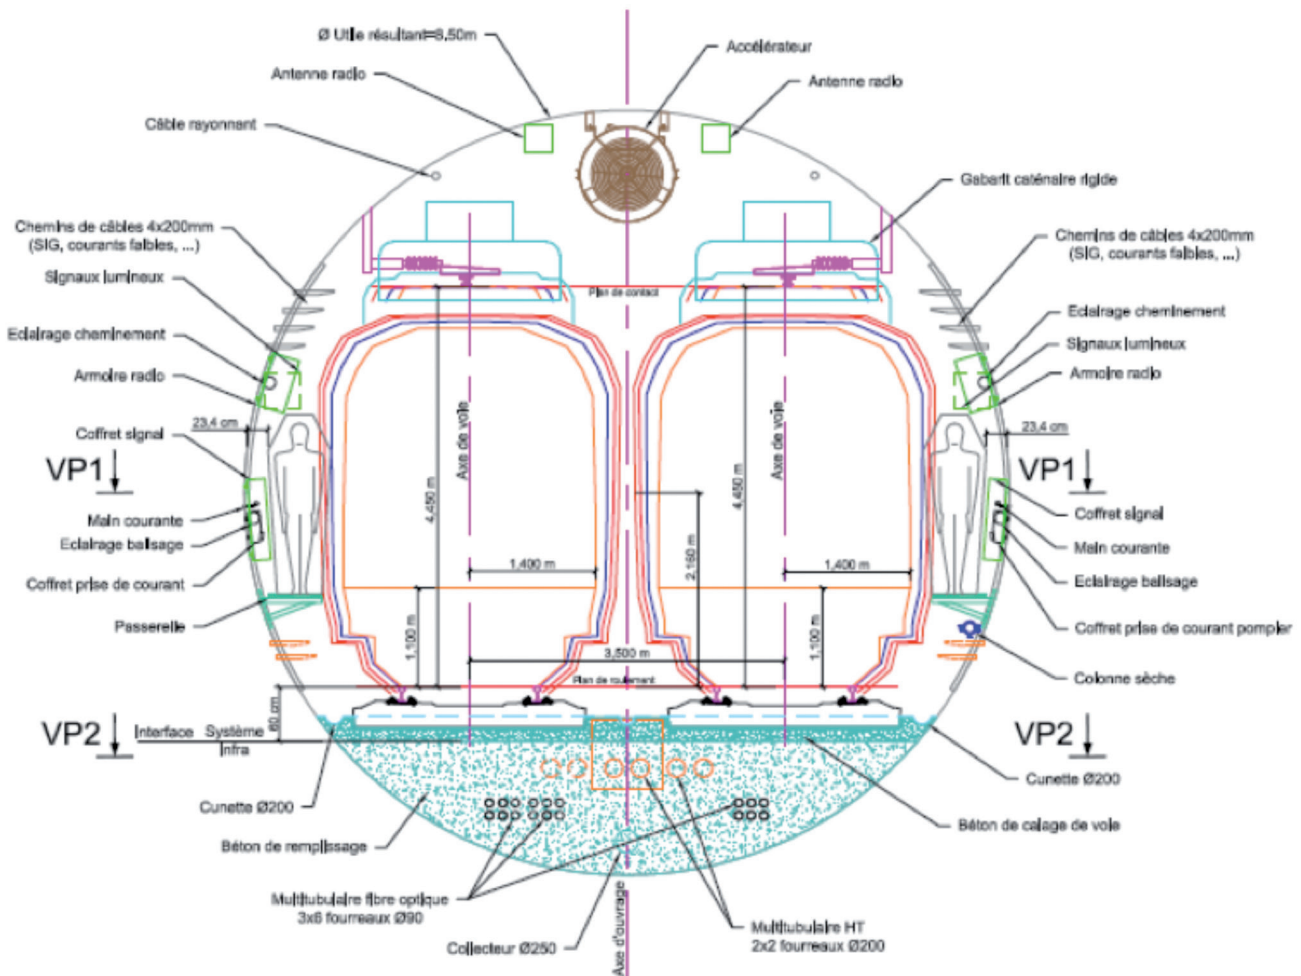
Coupe Tunnel monotube bi-voies Ø 8,5 mètres – Section courante en alignement droit
